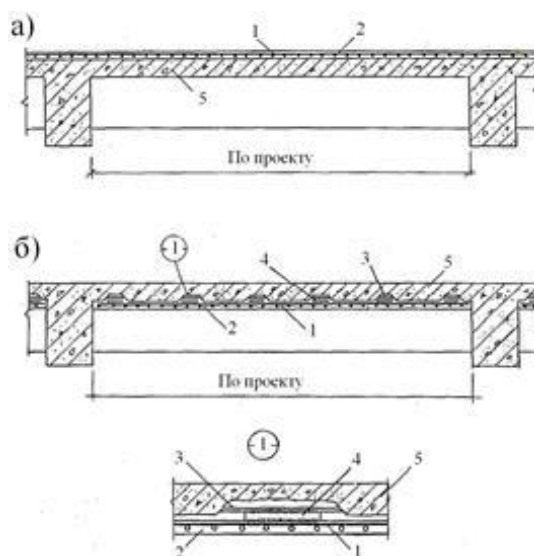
Усиление монолитной плиты перекрытия односторонним наращиванием сверху (а) и снизу (б): 1 – проектируемая арматурная сетка; 2 – новый бетон; 3 – существующая арматура; 4 – кортыши через 700 мм; 5 – усиливаемая плита
